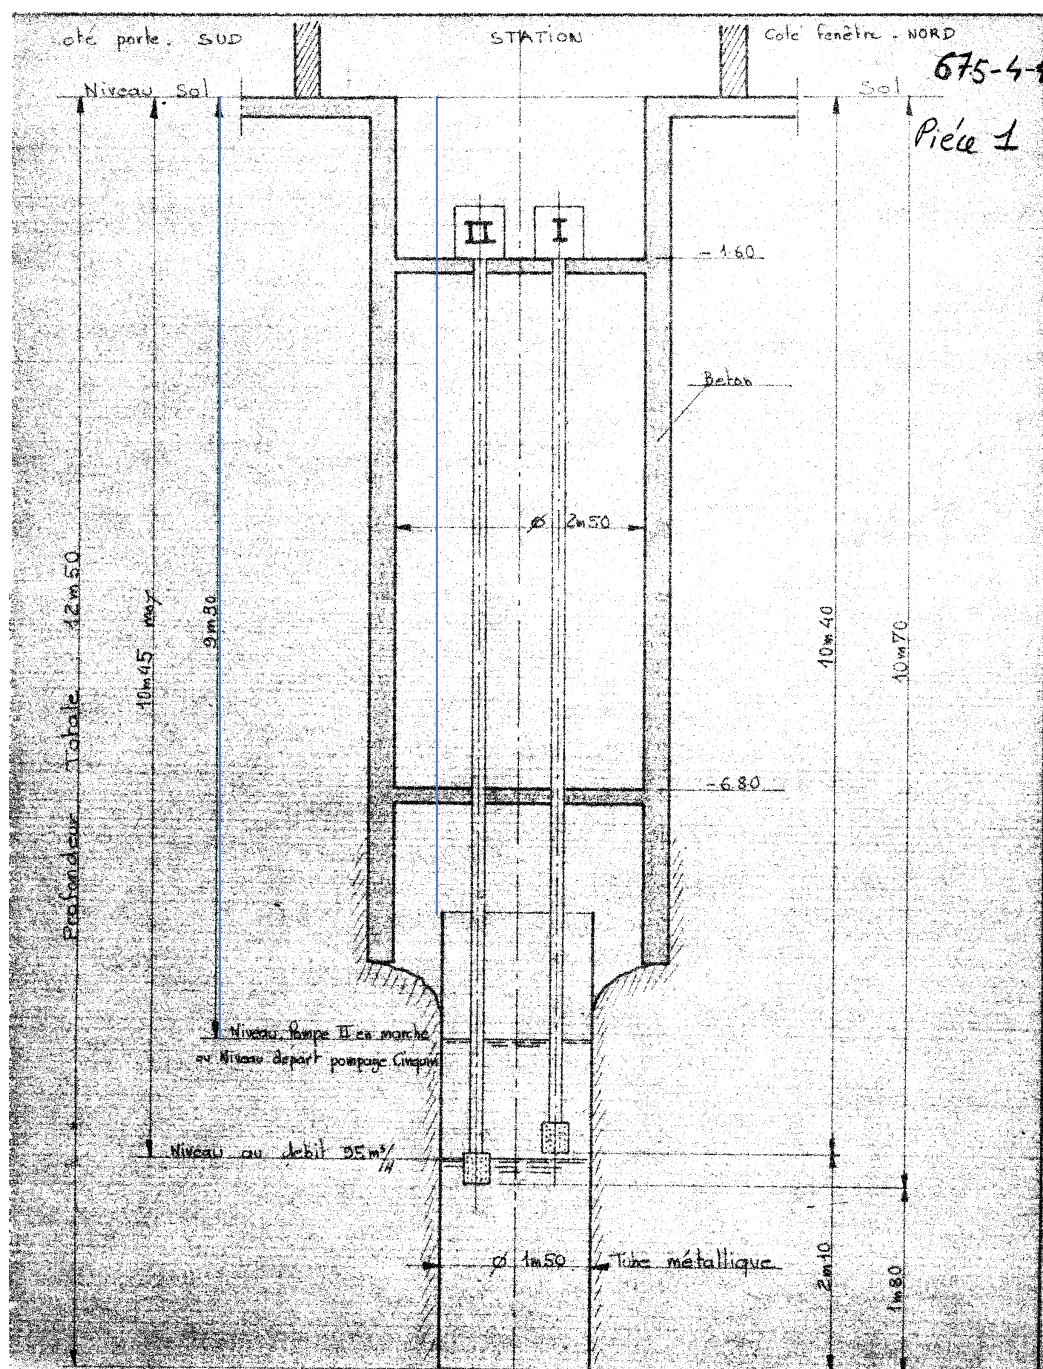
Coupe technique du puits du Bellaton (source : Infoterre)
